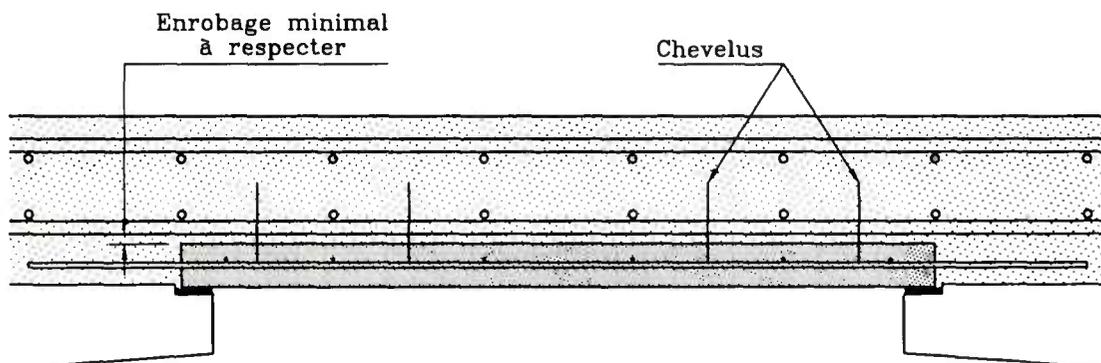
Exemple de ferrailage du hourdis sur coffrages perdus non participants.
